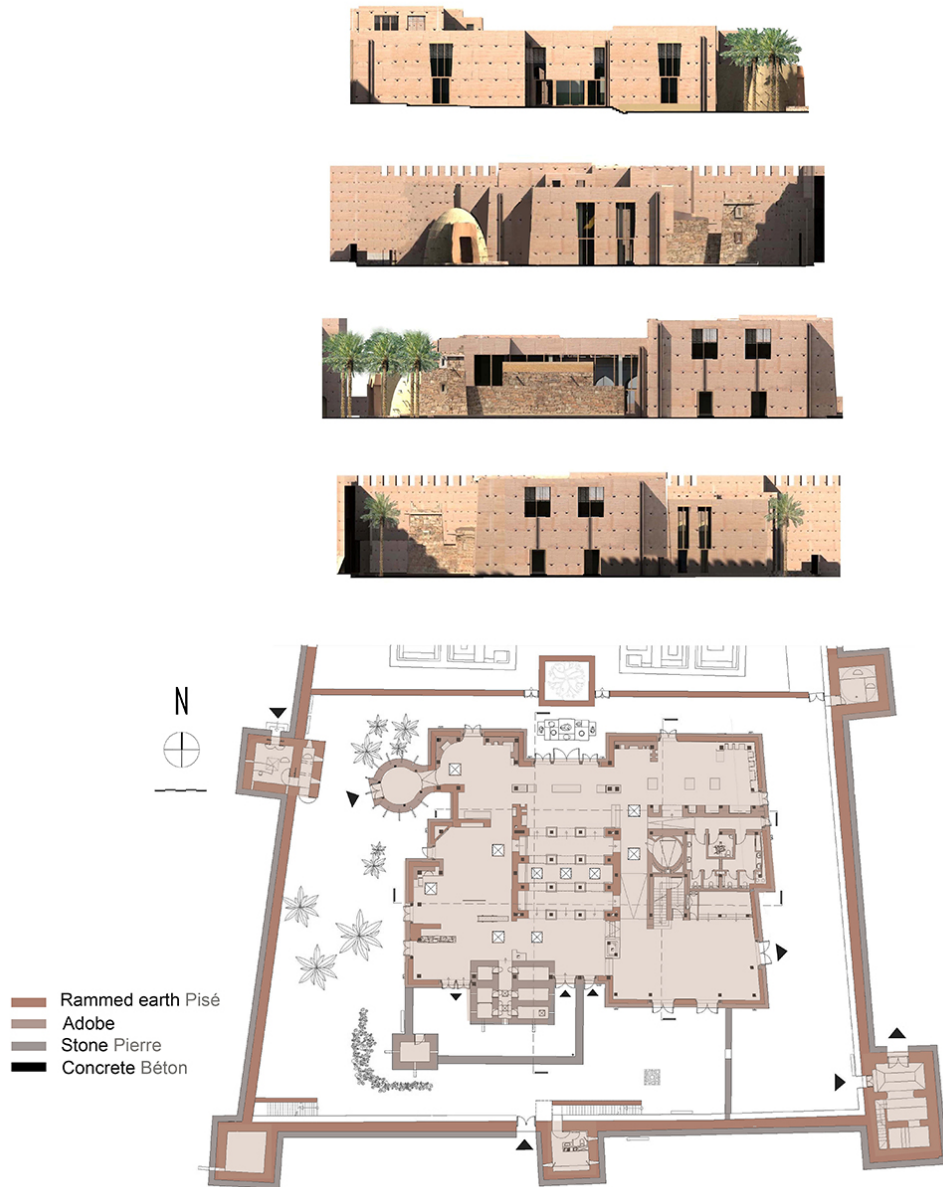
Plan des matériaux, façades, Salima Naji ©.
